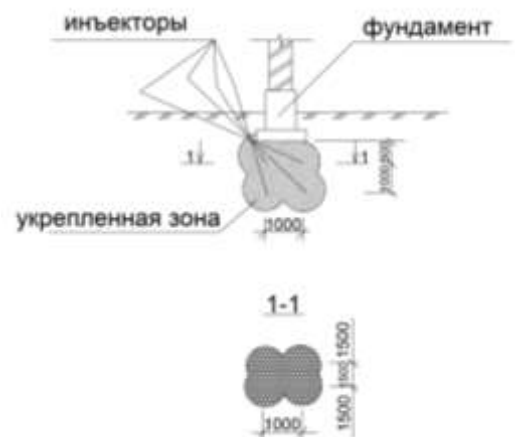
Схема цементации основания под ленточными фундаментами здания.
